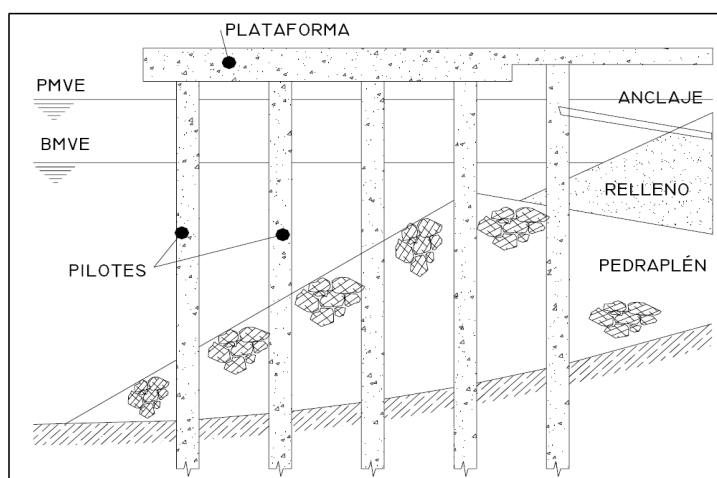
Sección tipo de un muelle plataforma sobre pilotes
